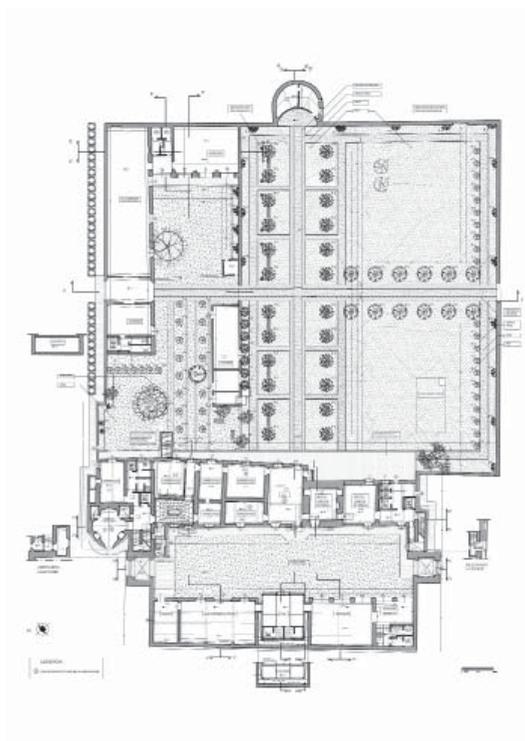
Il castello dell'Acciaio: pianta piano terra di progetto
